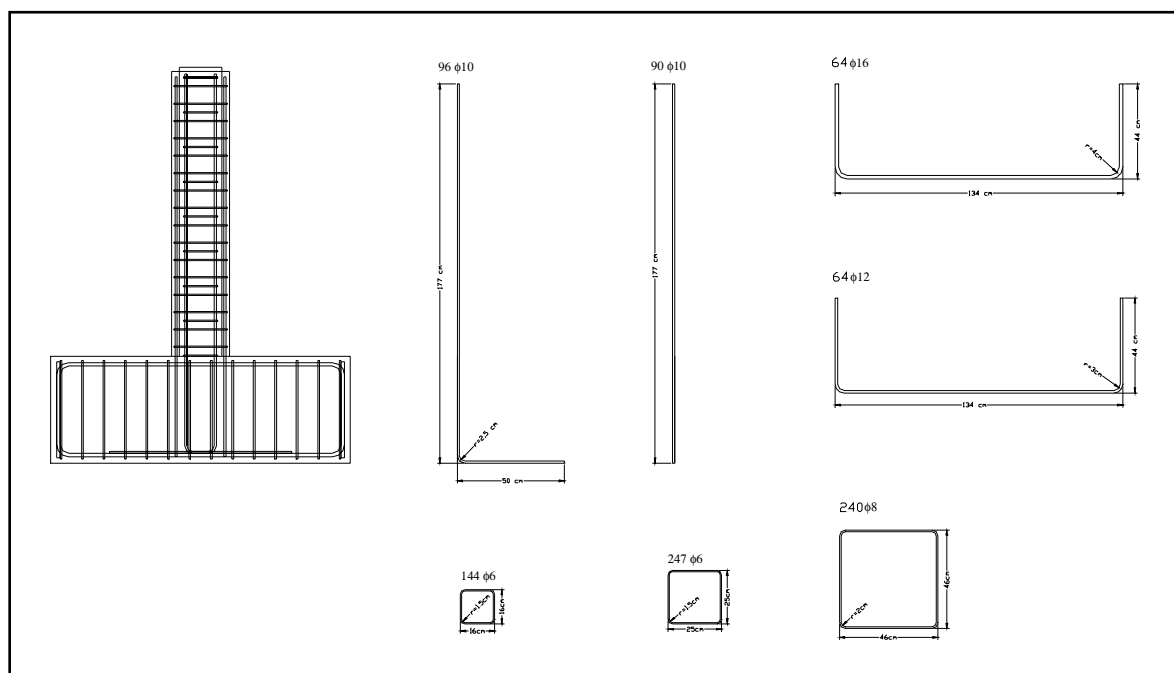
Armaduras do pilar original, do reforço e da sapata.
